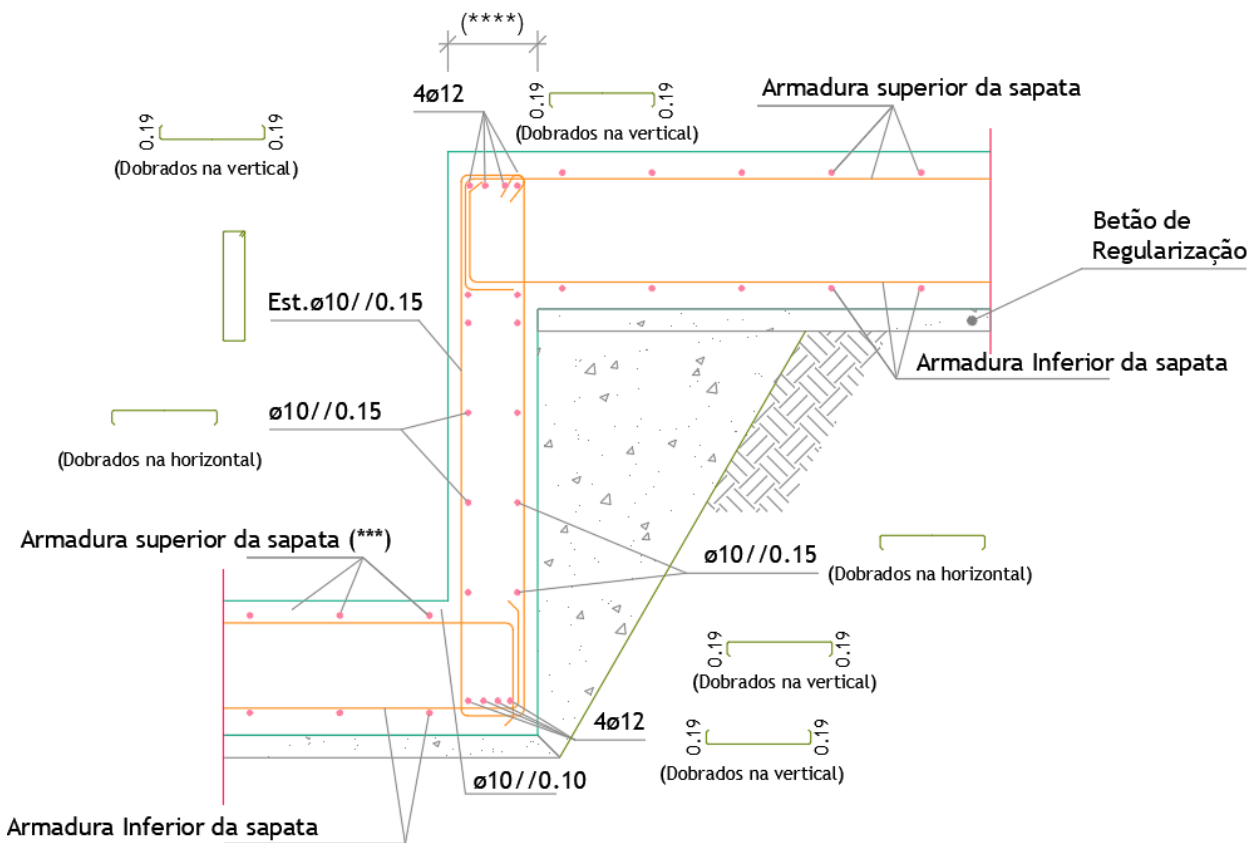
Pormenor dos Desníveis das Sapatas dos Muros de Suporte (Projeto de estruturas).
